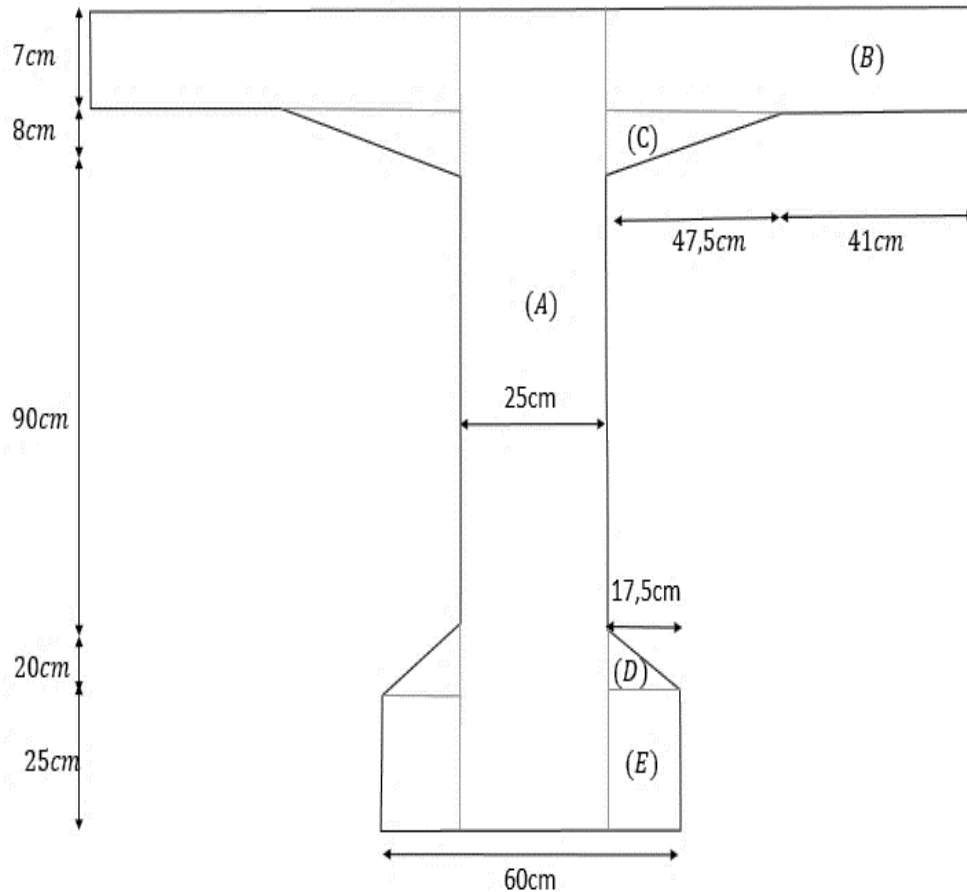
Section de la poutre seule (intermédiaire et rive)
